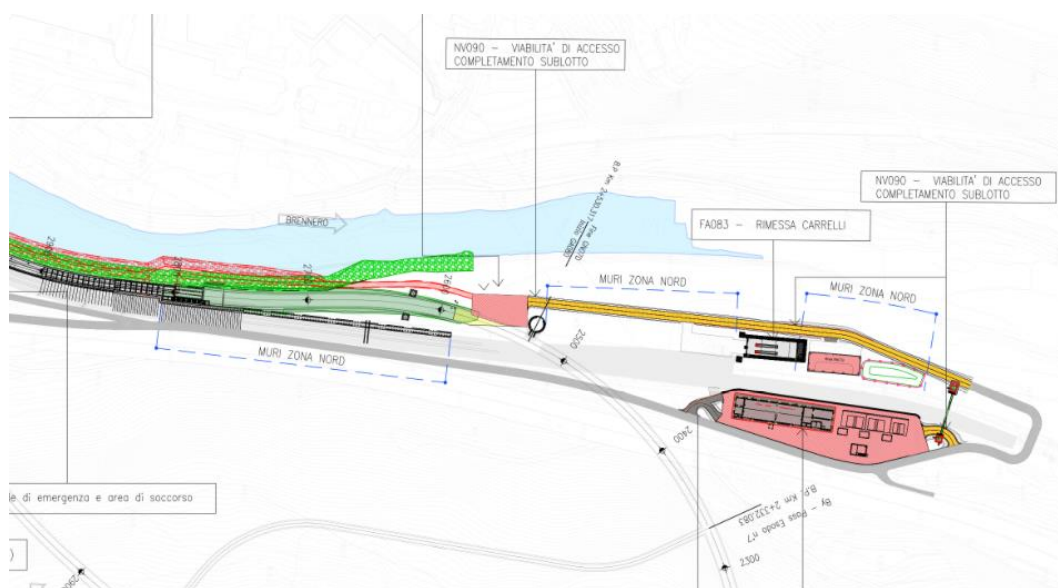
Planimetria di PE in zona Ponte Gardena - configurazione dei tralicci Terna mantenuta invariata rispetto allo stato attuale
